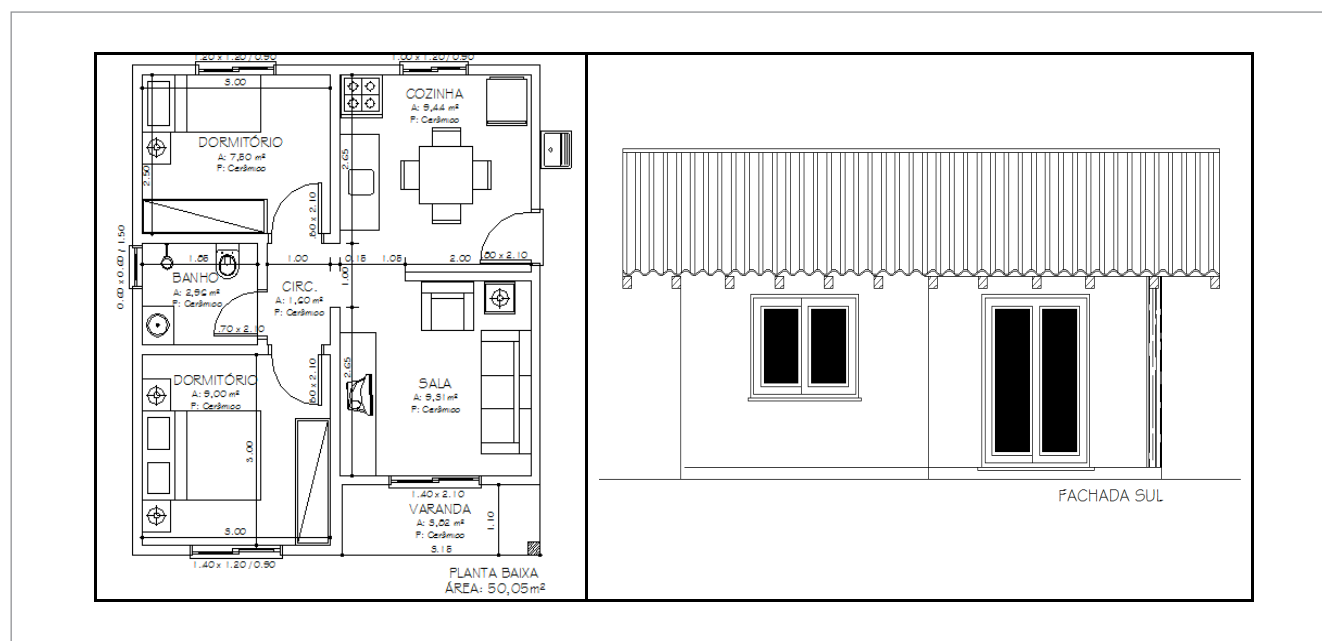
Primera etapa de la obra. Fuente: Taller de arquitectura responsable por el proyecto
